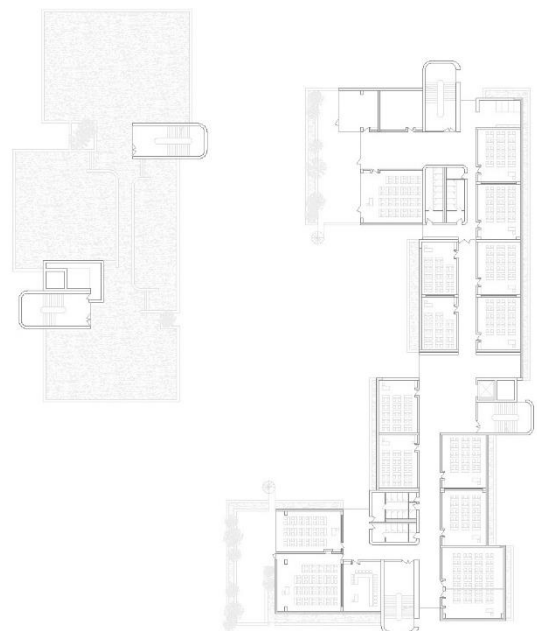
Abb. K: Grundriss 3.OG, Planungsstand Genehmigungsplanung 1972 (Eigene Grafik nach Eingabeplanung LBK)
